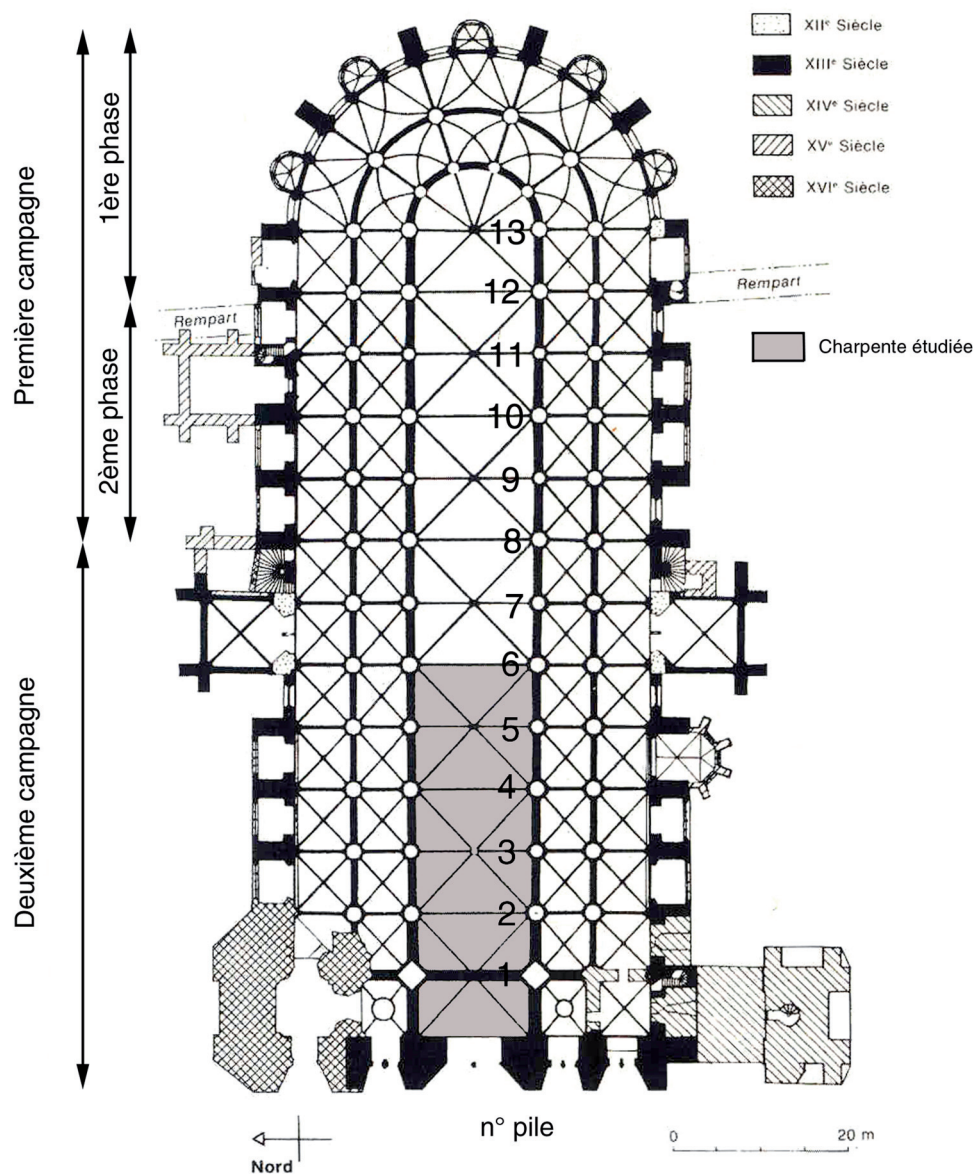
Plan de la cathédrale de Bourges (d'après plan Ribault 1995 : 27).
